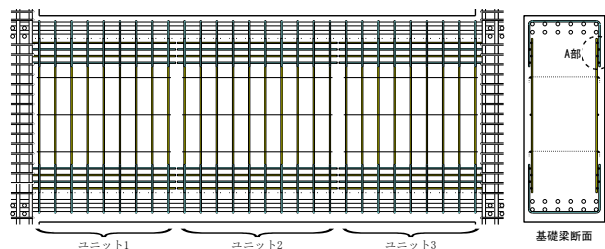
本工法による溶接鉄筋ユニットの立面配置例
